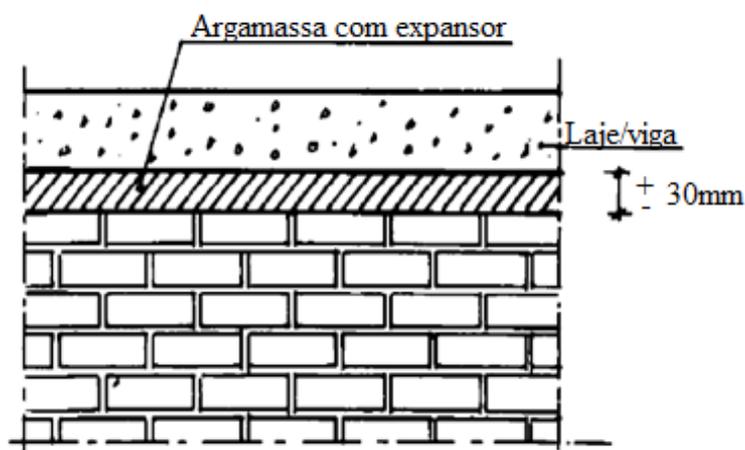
Travamento entre alvenaria e estrutura realizado por argamassa com expansor.
